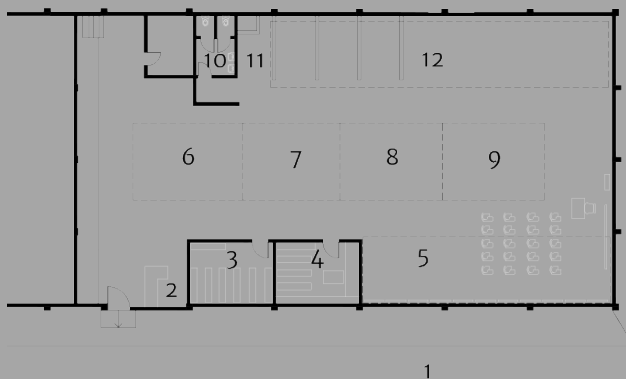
Planta esquemática galpão do canteiro-escola.
